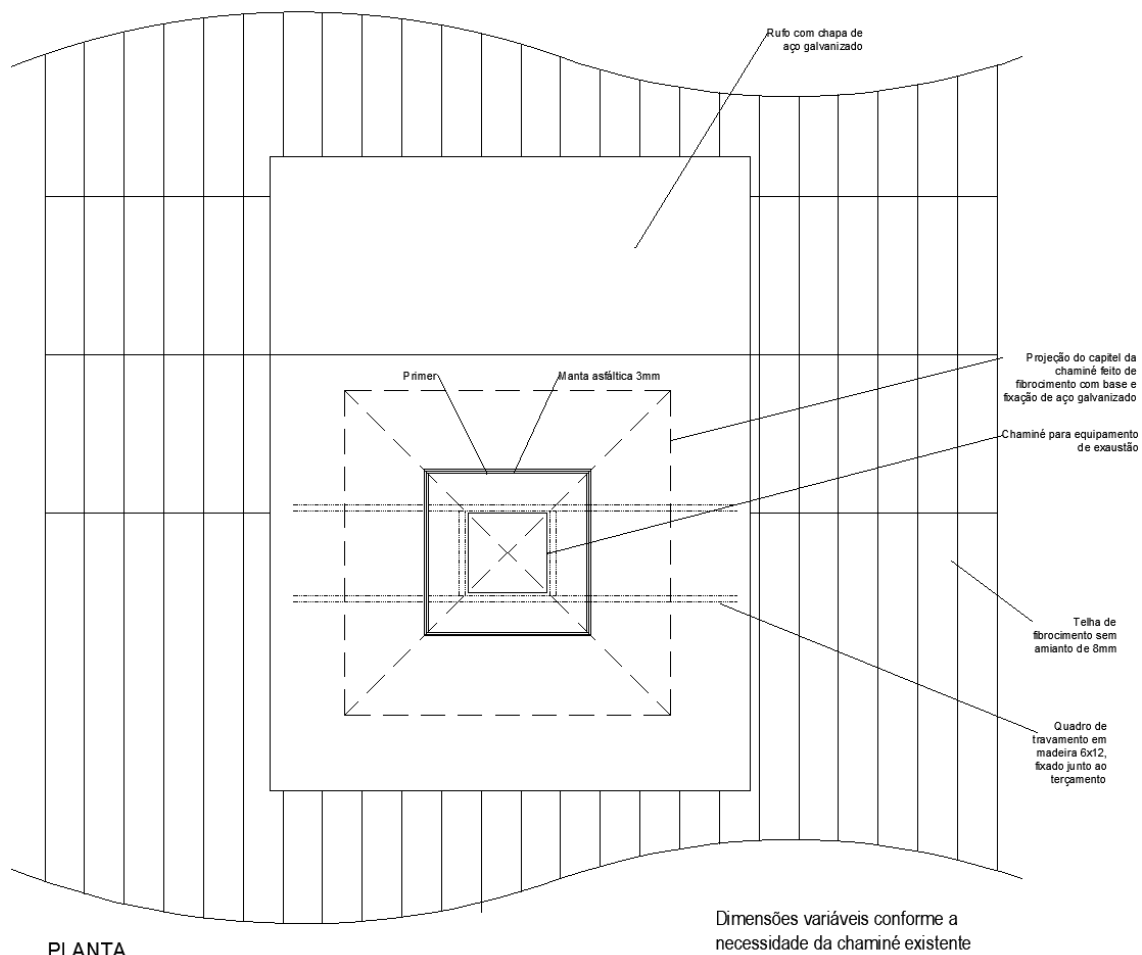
Sistema de proteção em chapa de aço galvanizado a ser executado
